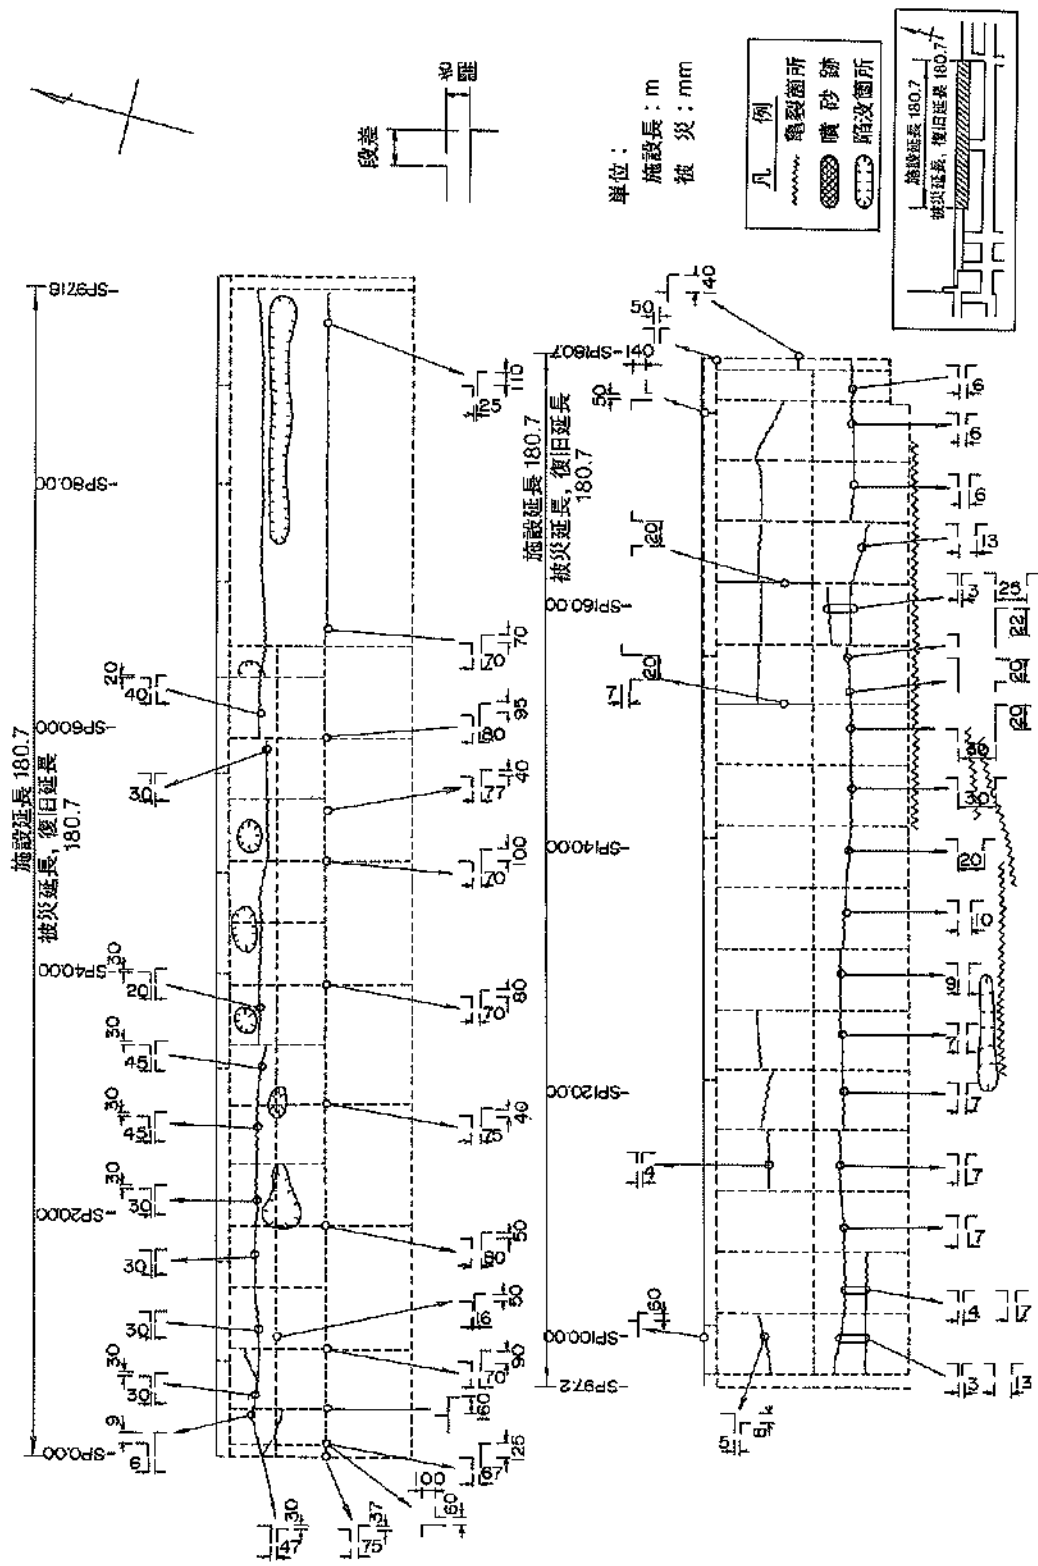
平面図・縦断面図・標準断面図 (⑨)岸壁 (中央-5.5m) 東側)
